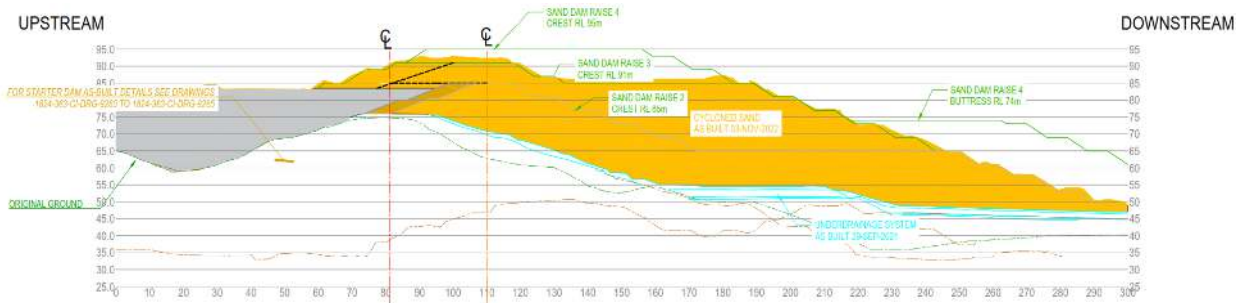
3: Sección de Presa Norte As-Built en 1+250 – 03/noviembre/2022
